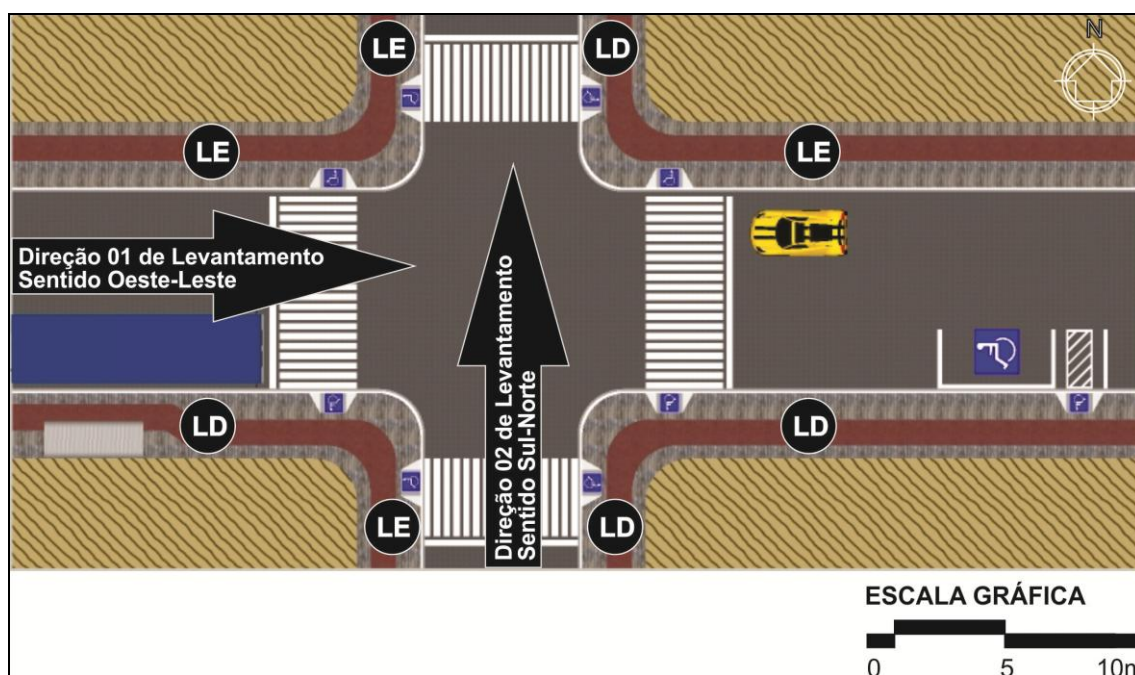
Direções adotadas para orientação do levantamento físico.
